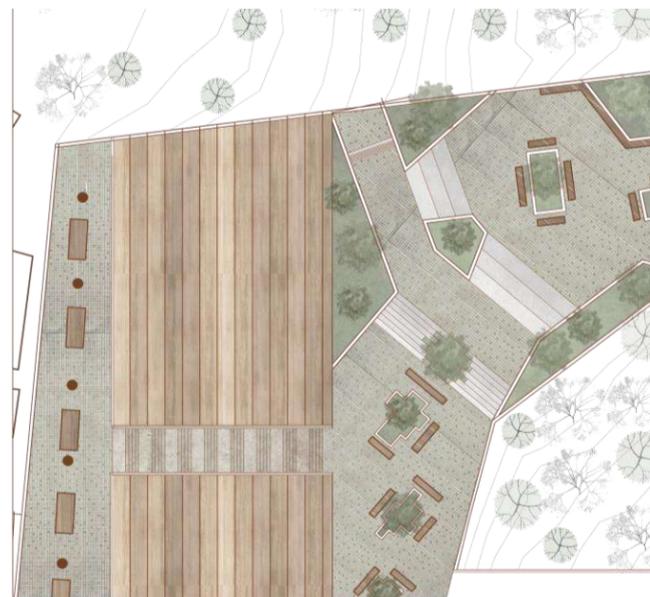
PLANTA 1 – ESPACIO PÚBLICO
